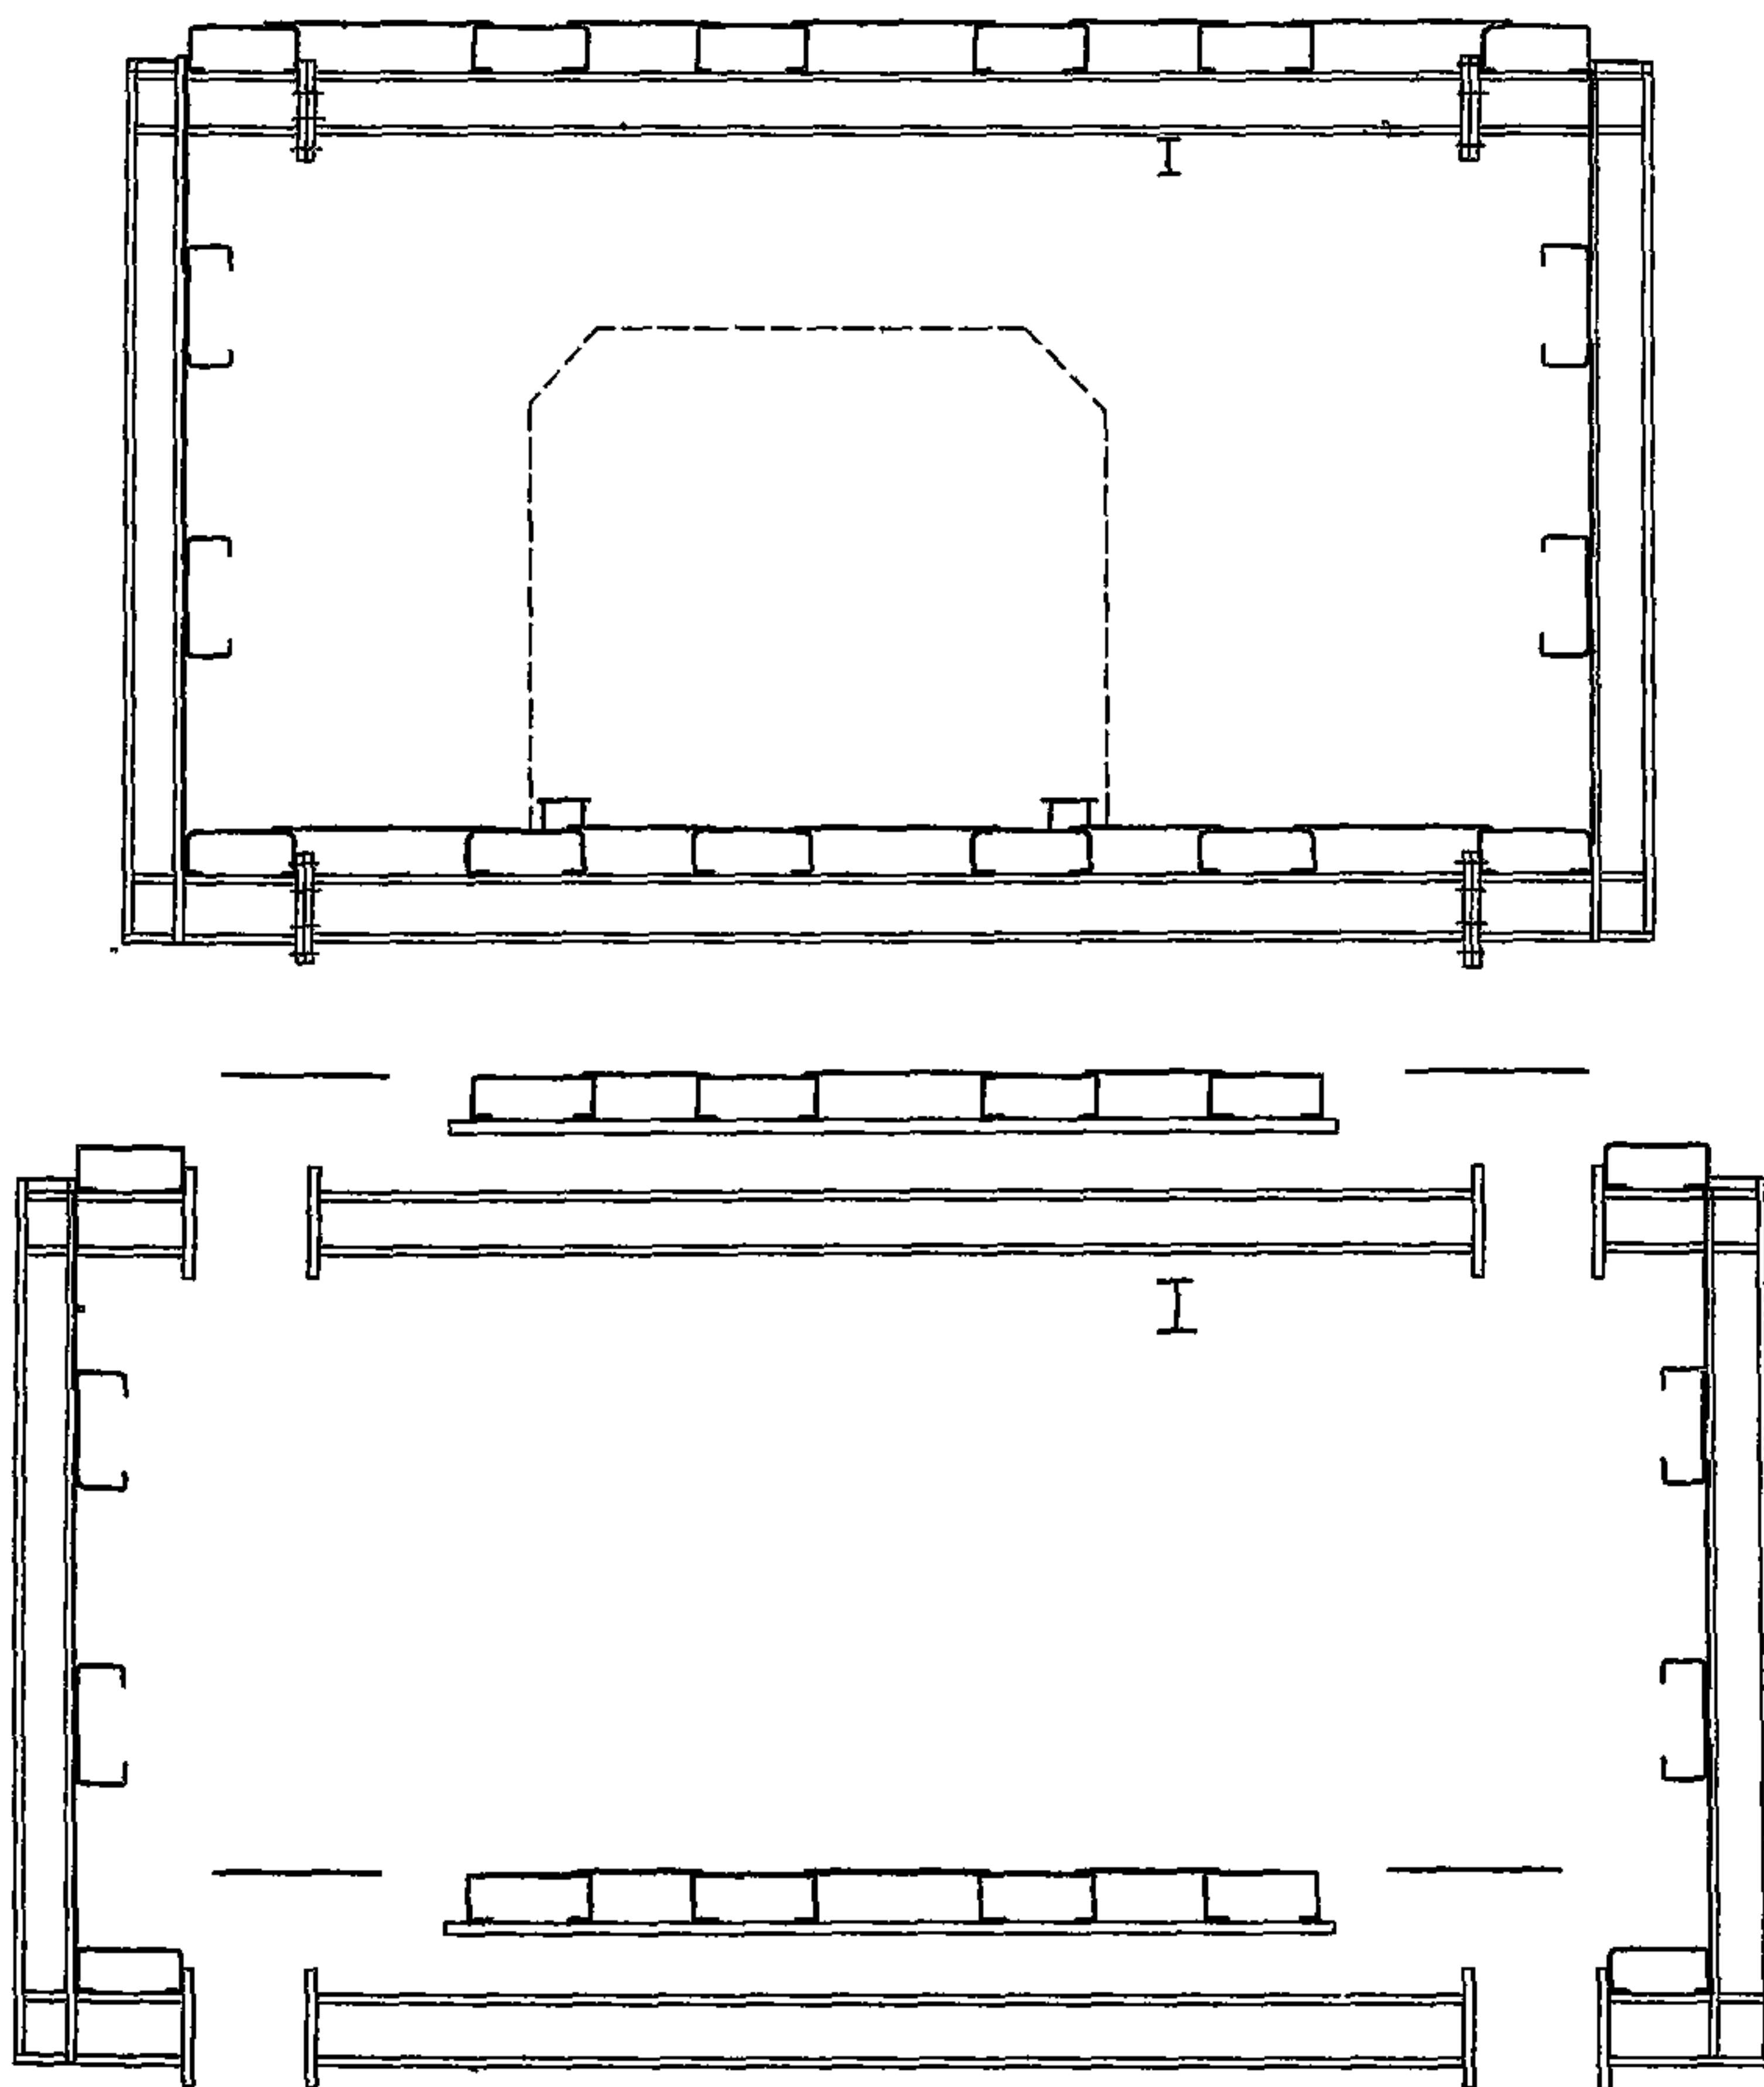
Поперечное сечение пролетного строения из прямоугольной оболочки со стеновыми панелями швеллерного сечения
